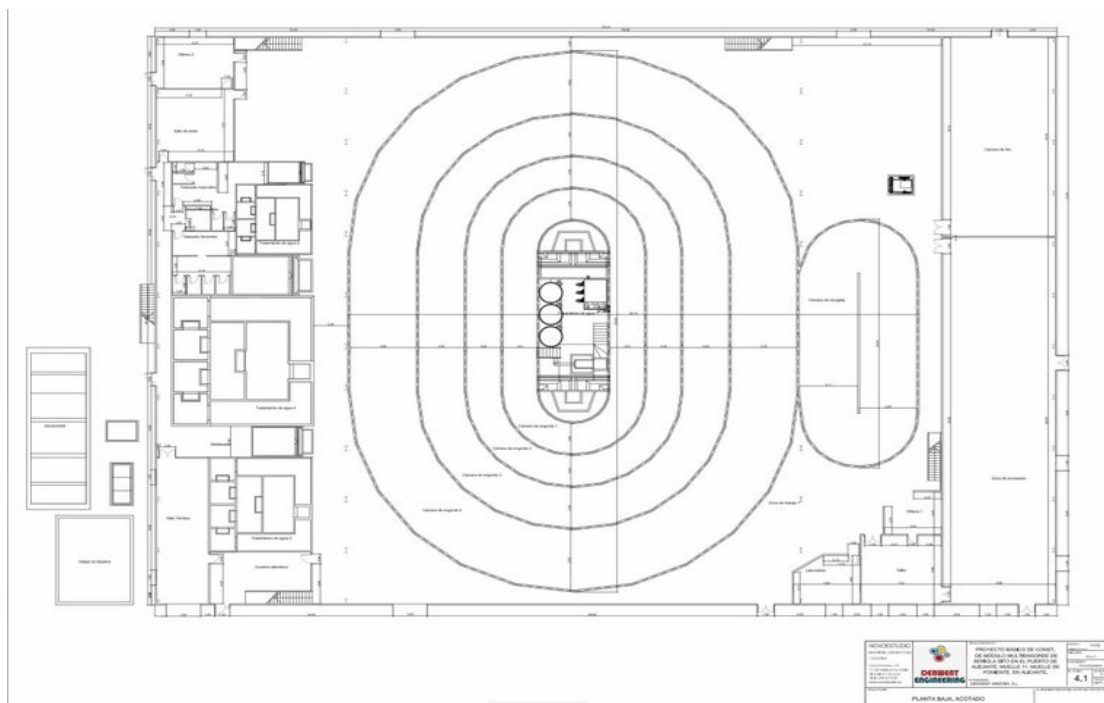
Plano de planta de la granja de engorde proyectada. (Fuente: proyecto técnico)
